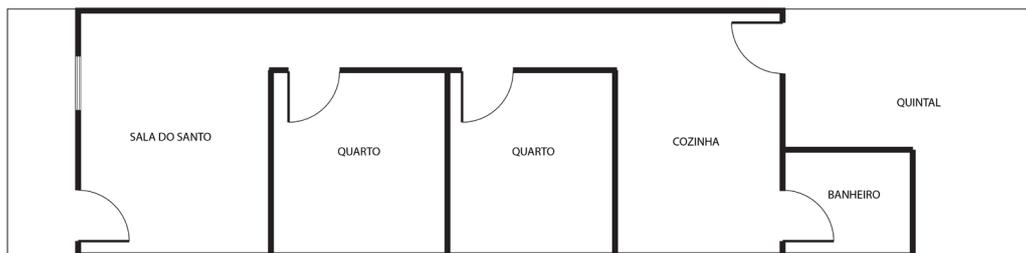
Planta de uma casa típica do Horto (Amadeu Mariano³, 2019).
